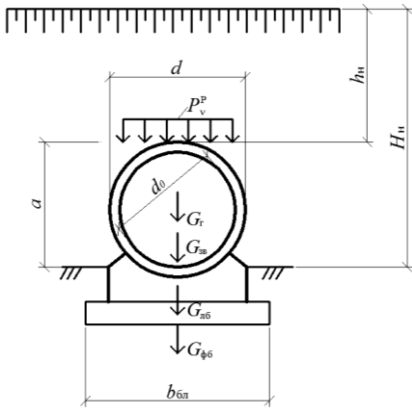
Схема к определению расчетного вертикального давления на звенья железобетонной трубы от постоянных нагрузок
